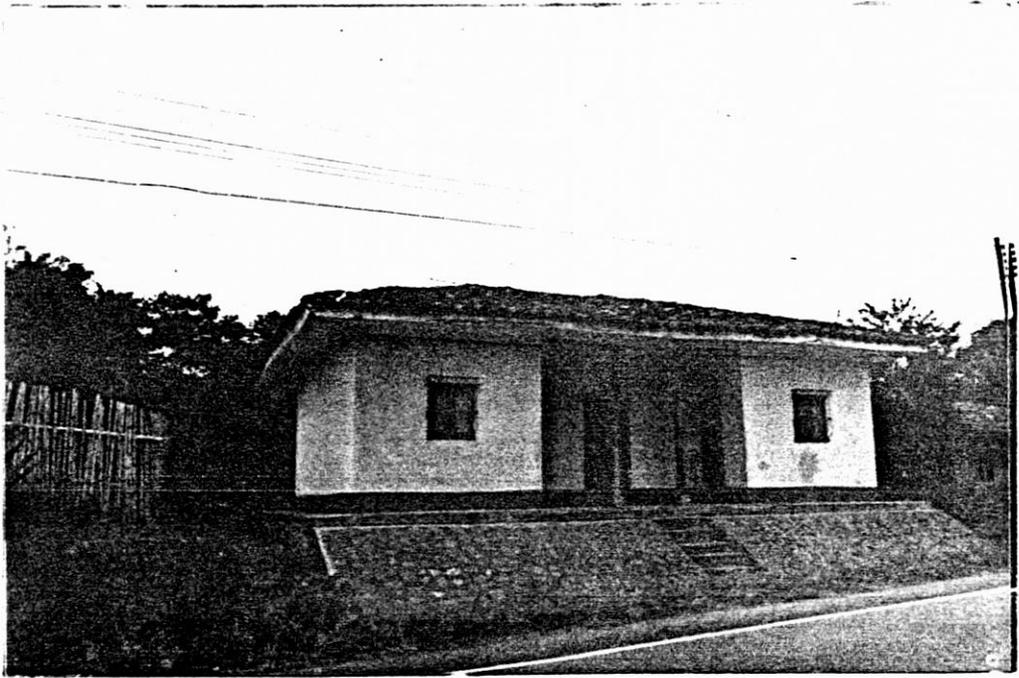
Vivienda rural de Santander de Quilichao (Cauca)
